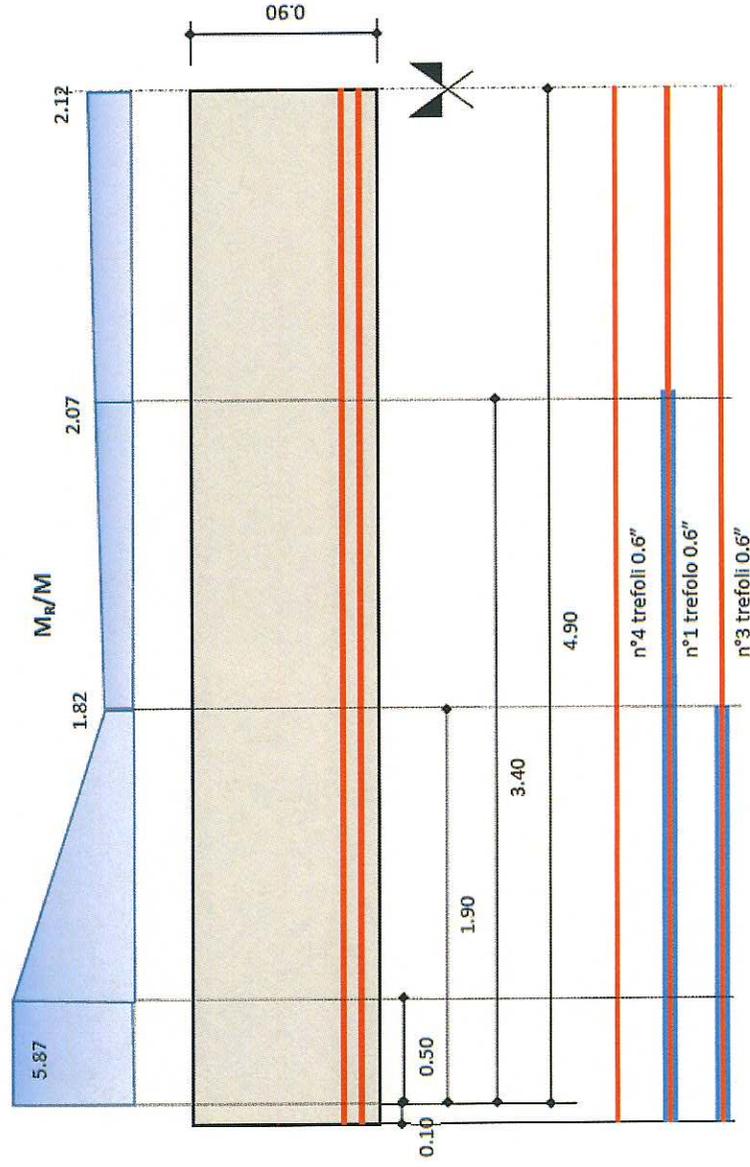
Schema della disposizione dei cavi nel tegolo da 3.5 m e rappresentazione del rapporto  $M_R/M$ .
